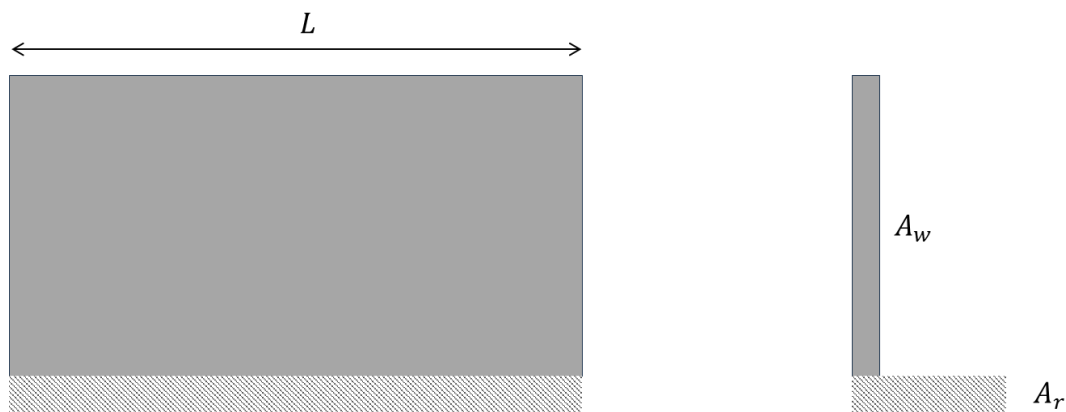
voile bridé à sa base – béton non fissuré
